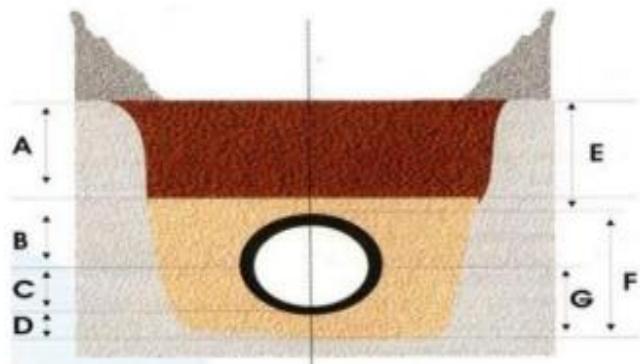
Pose et la protection de la conduite en tranchée. [10]
